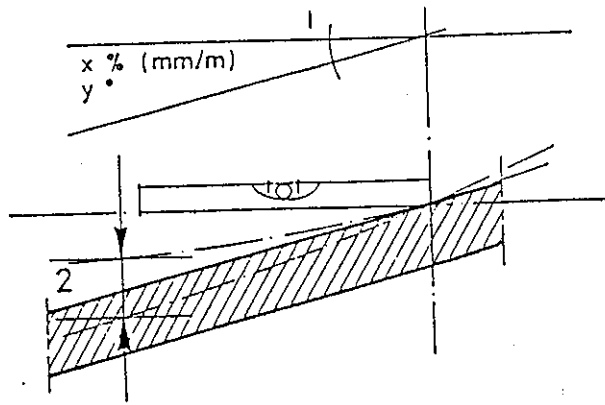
Contrôle de la planéité d'un revêtement de sol.
